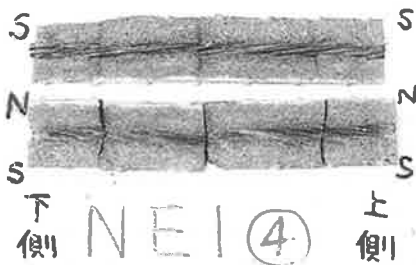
ひび割れ状況（PC 鋼より線 ④）
